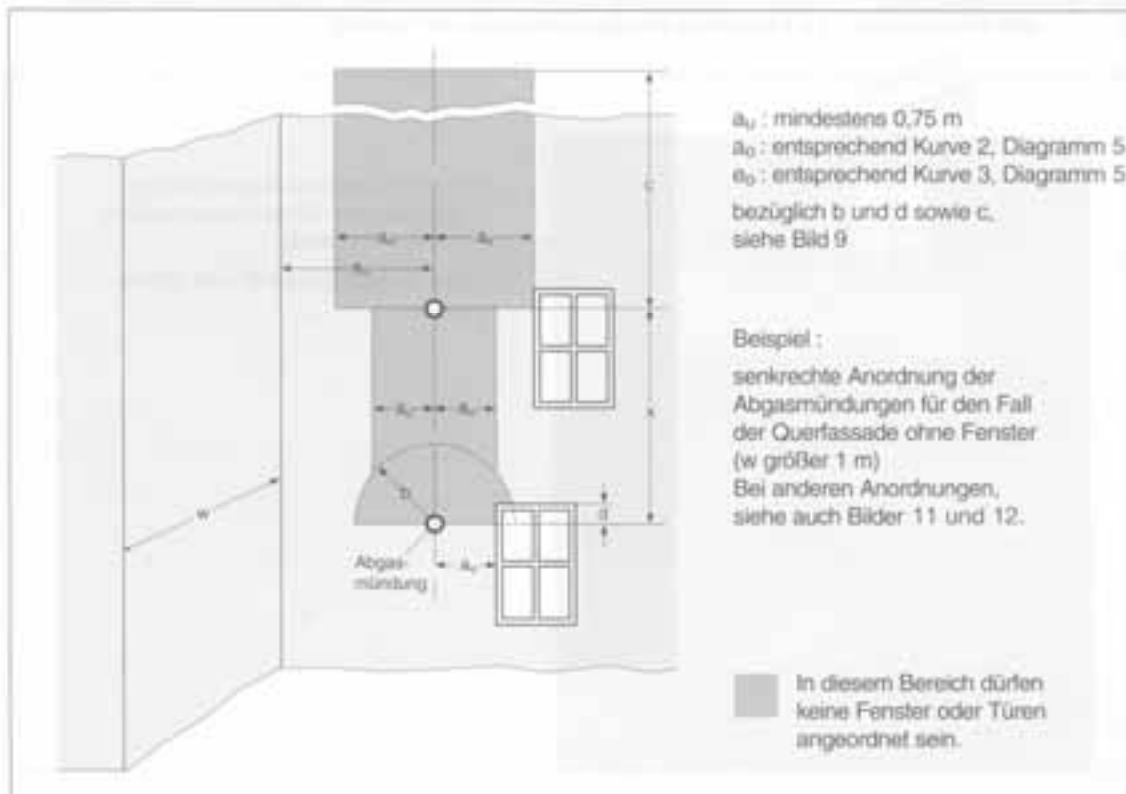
Mindestabstände von Abgasmündungen einer Zweier-Gruppe zu Fenstern, die geöffnet werden können, oder Fassadentüren – bei Fassaden in Ecklage (Querfassade ohne Fenster)
